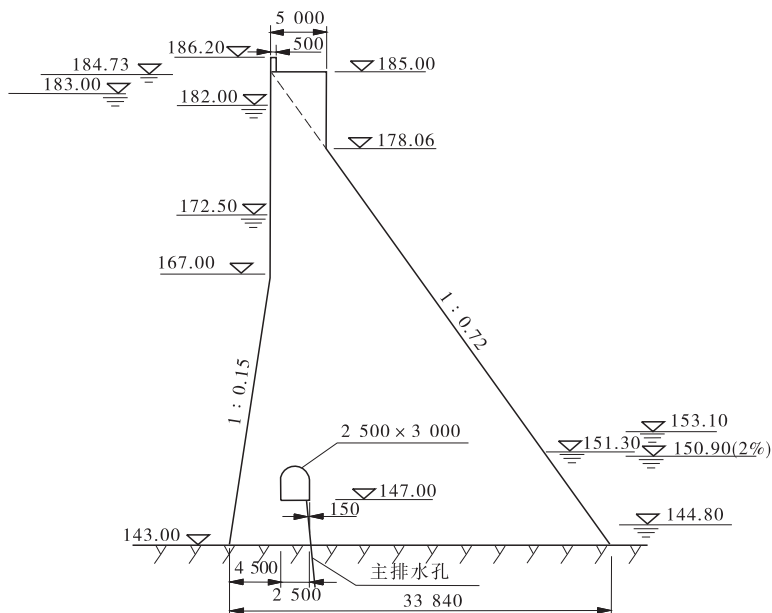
非溢流坝剖面 (尺寸单位:mm;高程单位:m)
